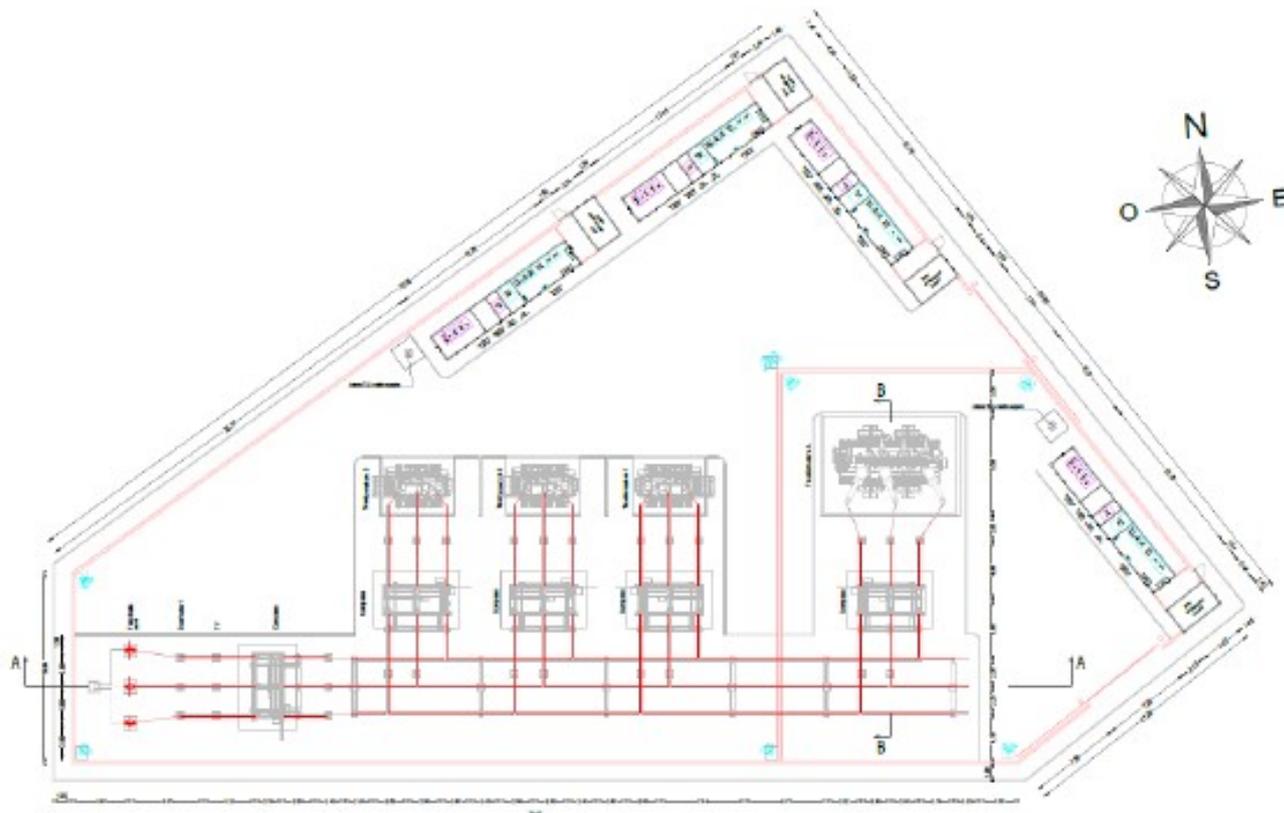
Layout della sotto-stazione utente
